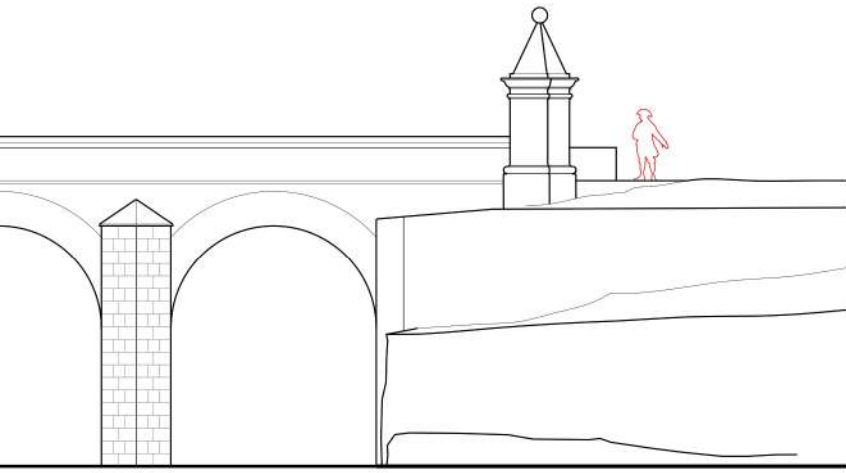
Planimetría del puente de Bosa (Autor, 2024).
